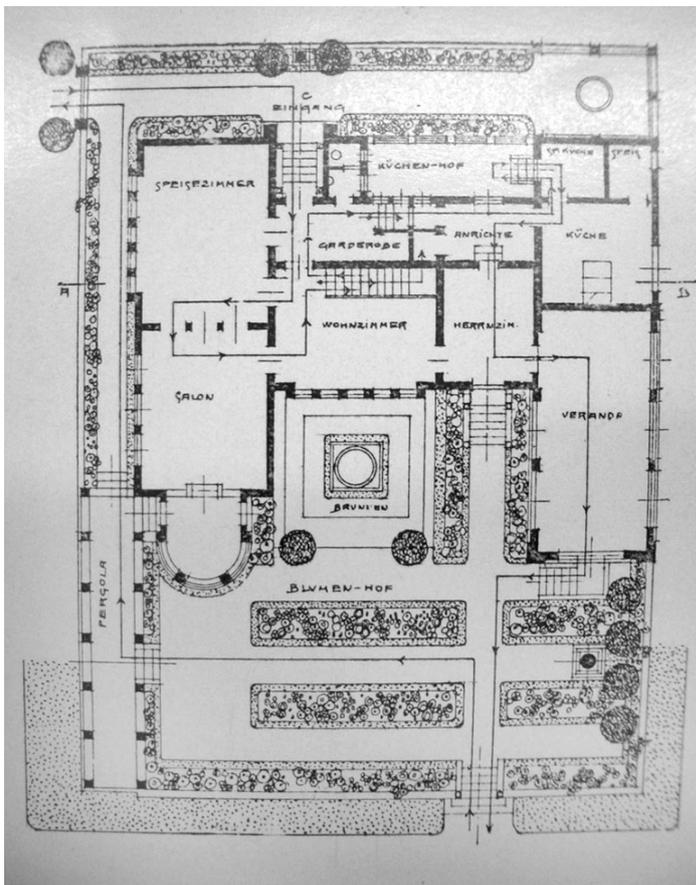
Entwurf einer Landhaus-Anlage von M. Kammerer für den Baukunstwettbewerb in Rom. 1910.
